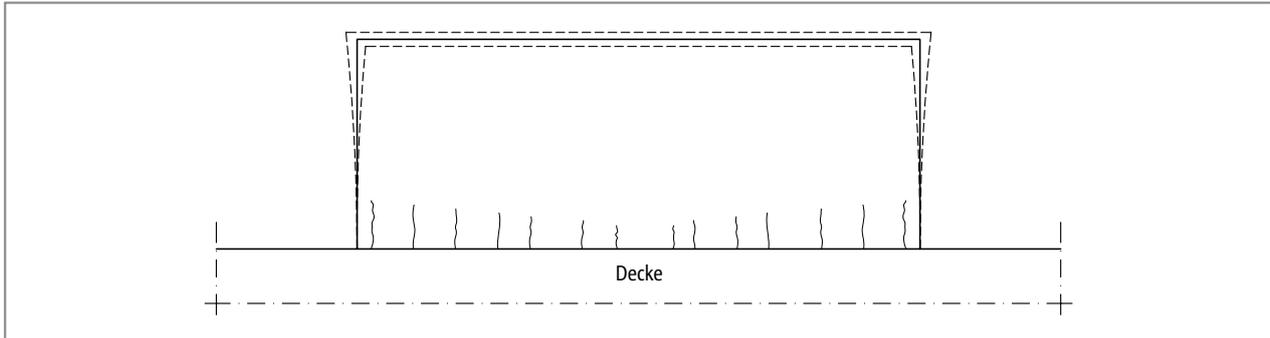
Balkonplatte ohne Schöck Isokorb®: Rissbildung durch Ermüdung möglich
